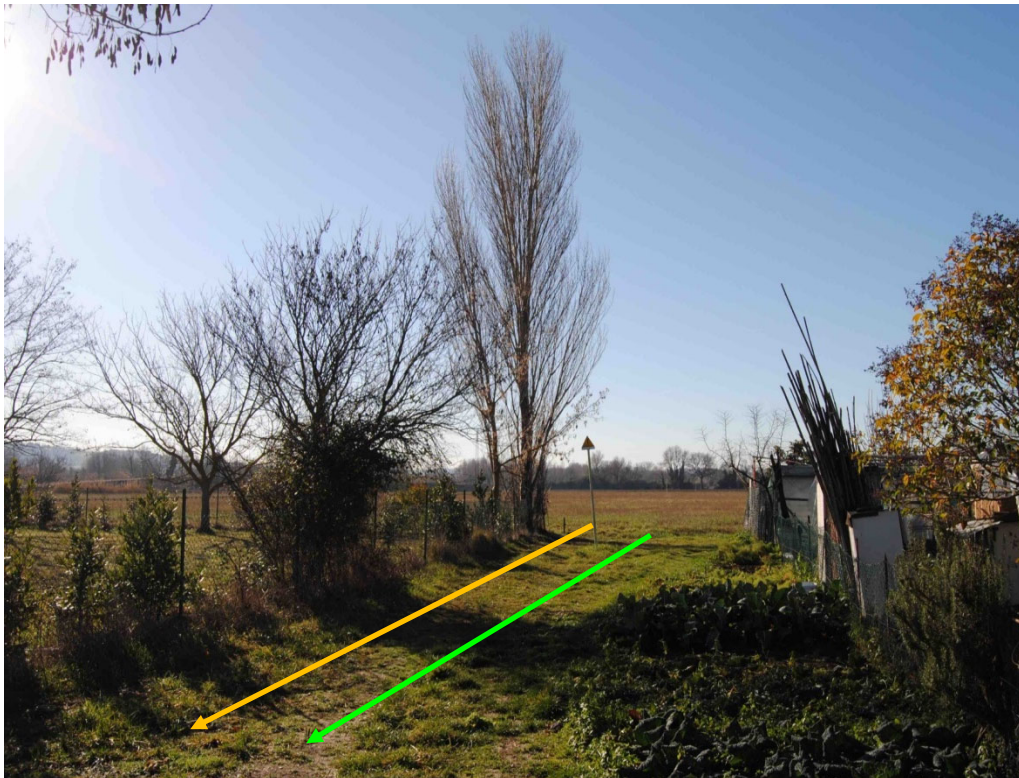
Filare attraversato dall'allacciamento in progetto Rif. Der. per Falconara 1° Tratto (freccia arancione) presso il Km 0+106
